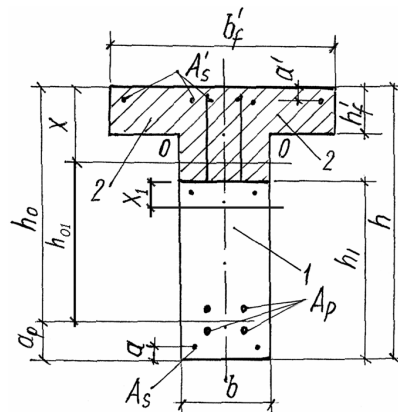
Поперечний переріз збірно-монолітних залізобетонних елементів таврової форми із балок і монолітної плити таврової форми
